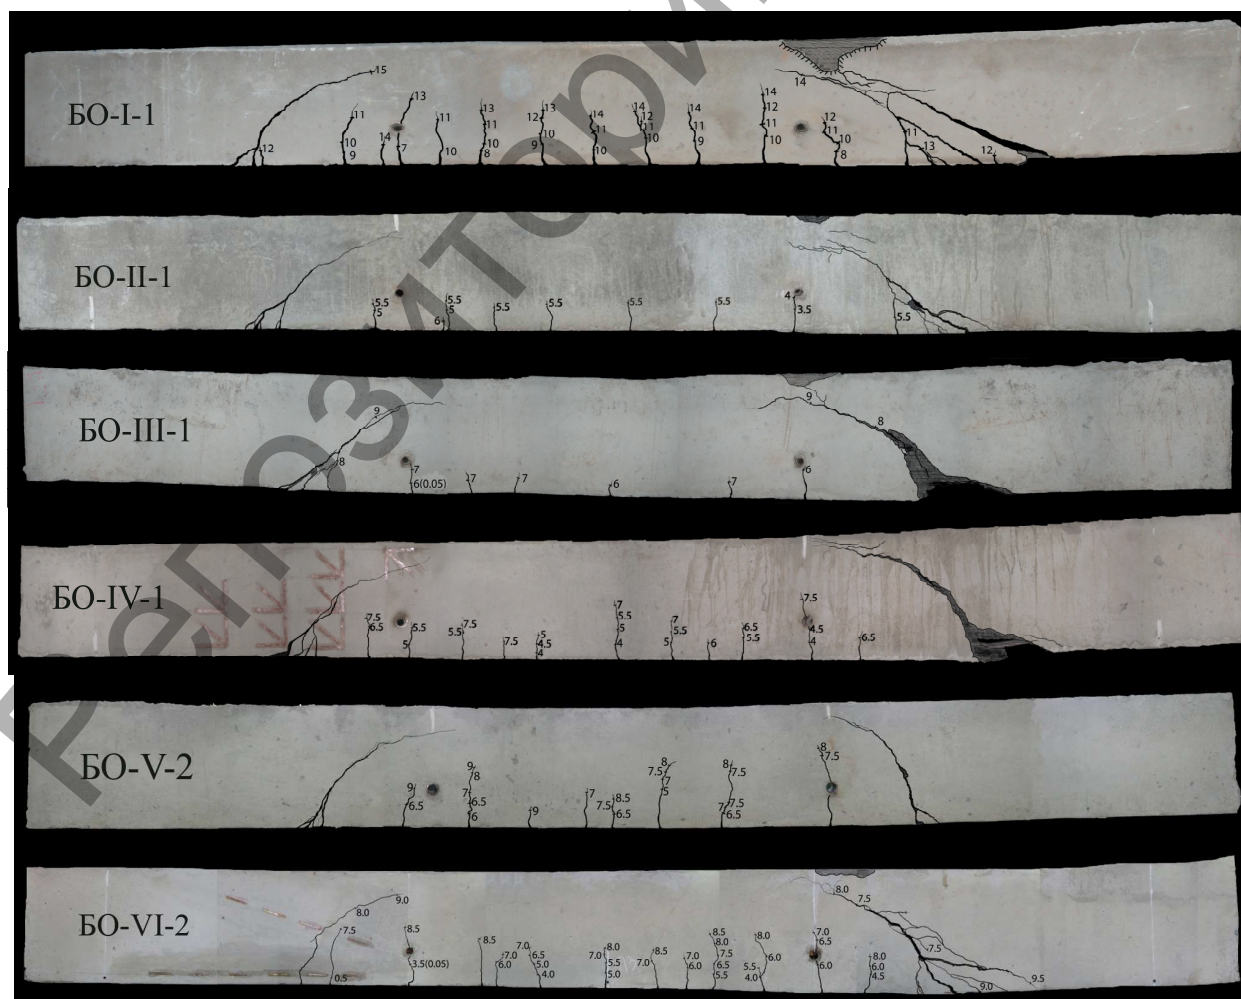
Трещинообразование и разрушение опытных балок группы БО
